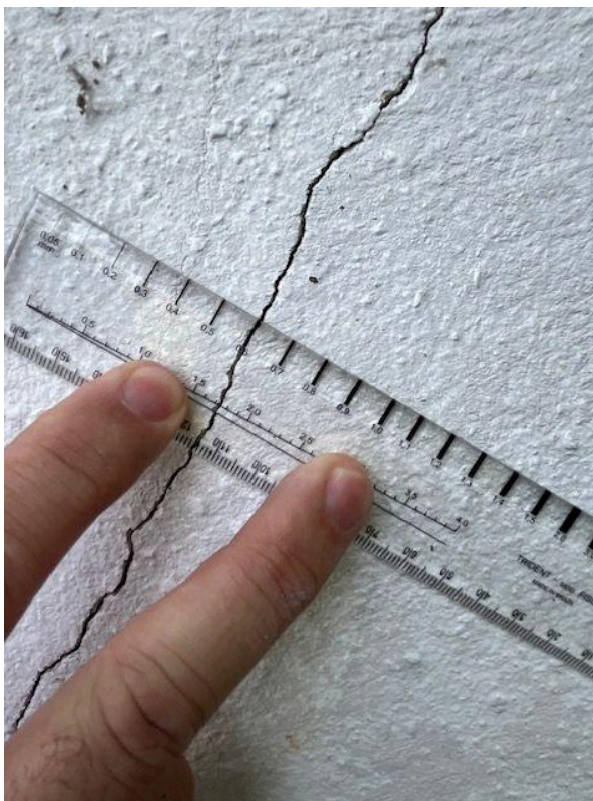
Marcação 2.8 - Fissuras em forro de gesso dos banheiros.
